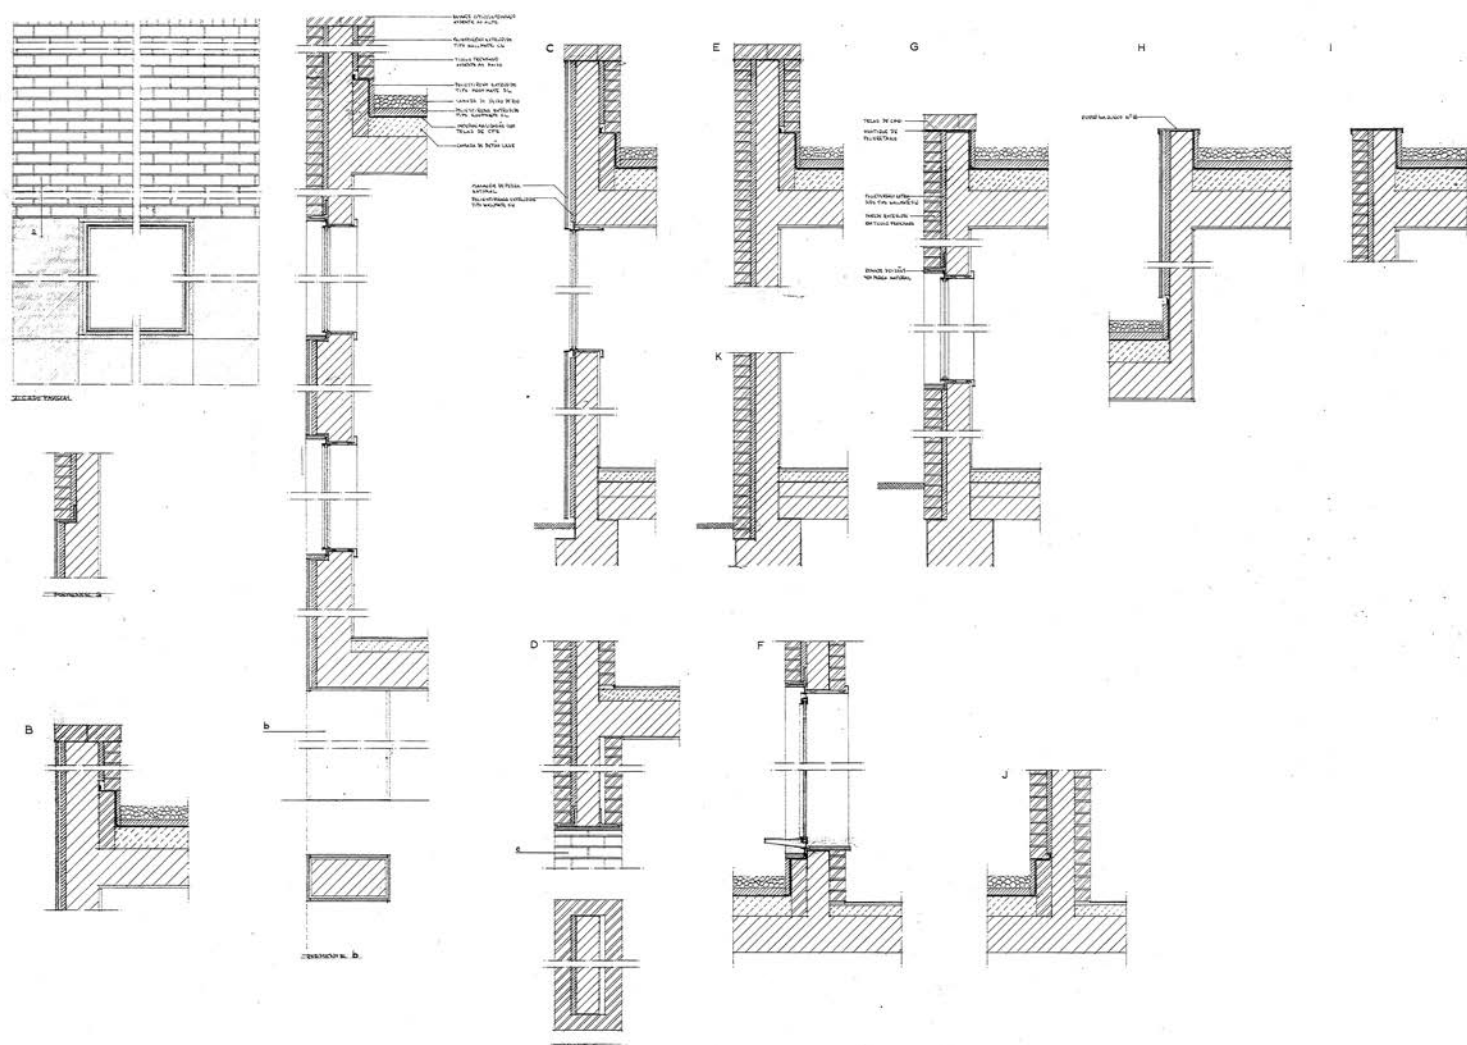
• Departamento de Engenharia Cerâmica – Projecto de Execução, Desenho n.º 13: Pormenores de fachada.
